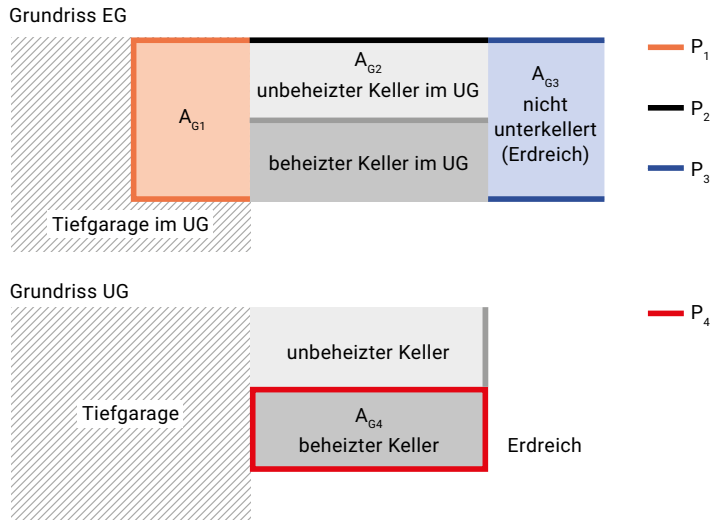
Grundrisse UG und EG Bürogebäude
